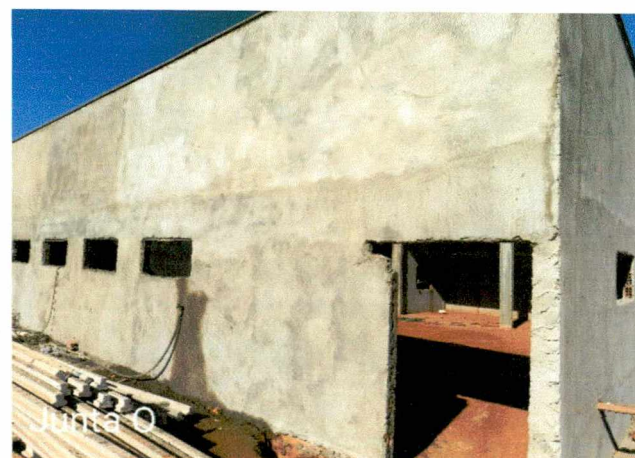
e 44: Execução de reboco interno e externo; concretagem do contrapiso (magro); execução de instalações (hidrossanitárias e infra dutos); regularização do contrapiso;
